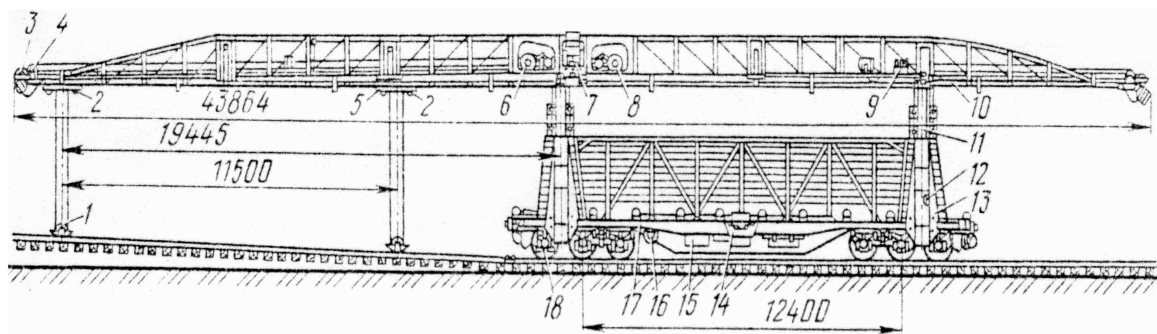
Укладальні крани УК 25/9 та УК25/18: 1 – вантажна обойма; 2 – крановий візок; 3 – вантажопідйомна лебідка; 4 – пост керування; 5 – тяглова лебідка; 6 – ферма; 7 – портална рама; 8 – кабіна керування платформою; 9 – силова установка; 10 – лебідка для протягування пакетів; 11 – рама
